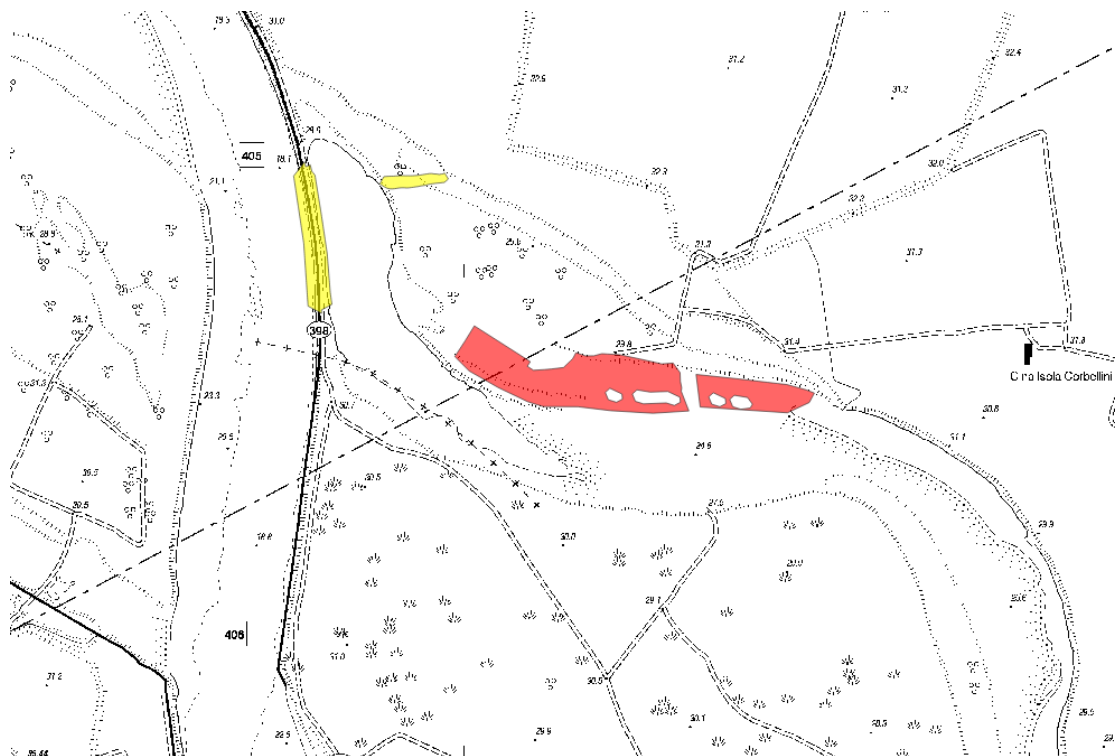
Planimetria delle aree di scavo (in giallo) e di riporto (in rosso) previste da progetto.
